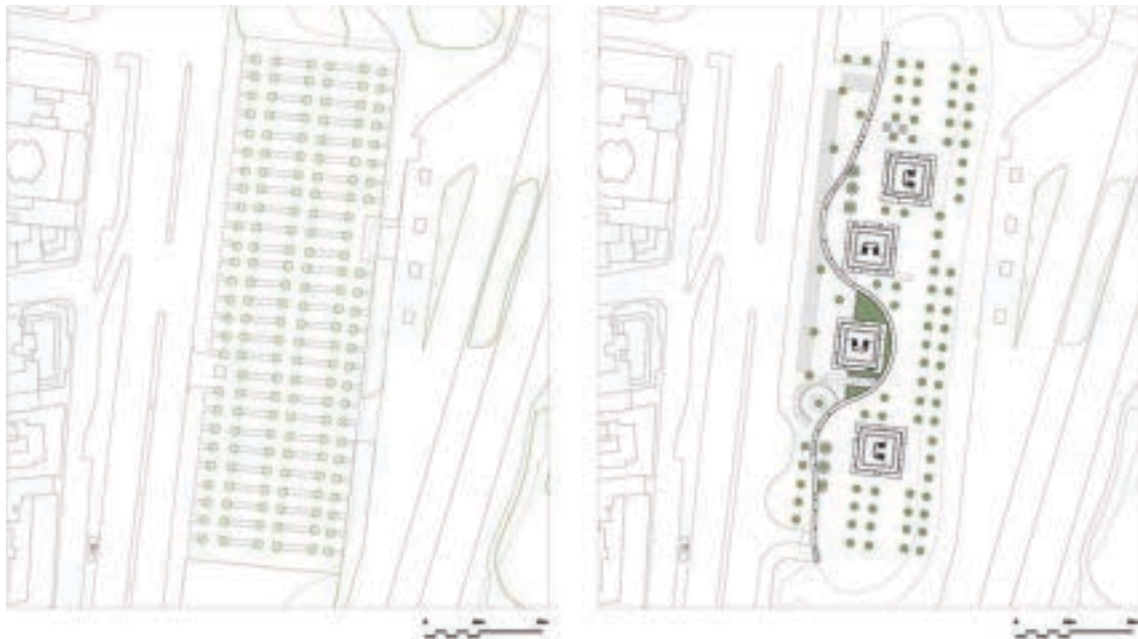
Planta do pré-existente, à esquerda, e planta de cobertura da 1ª fase da nova intervenção, à direita. (Ilustração nossa)
